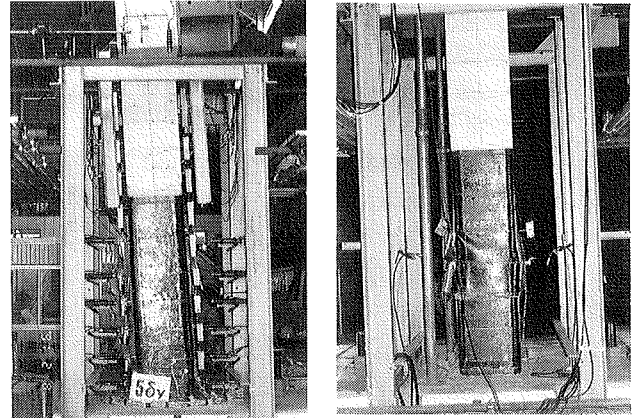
No. 1 試験体終局 写真-2 No. 2 試験体終局
